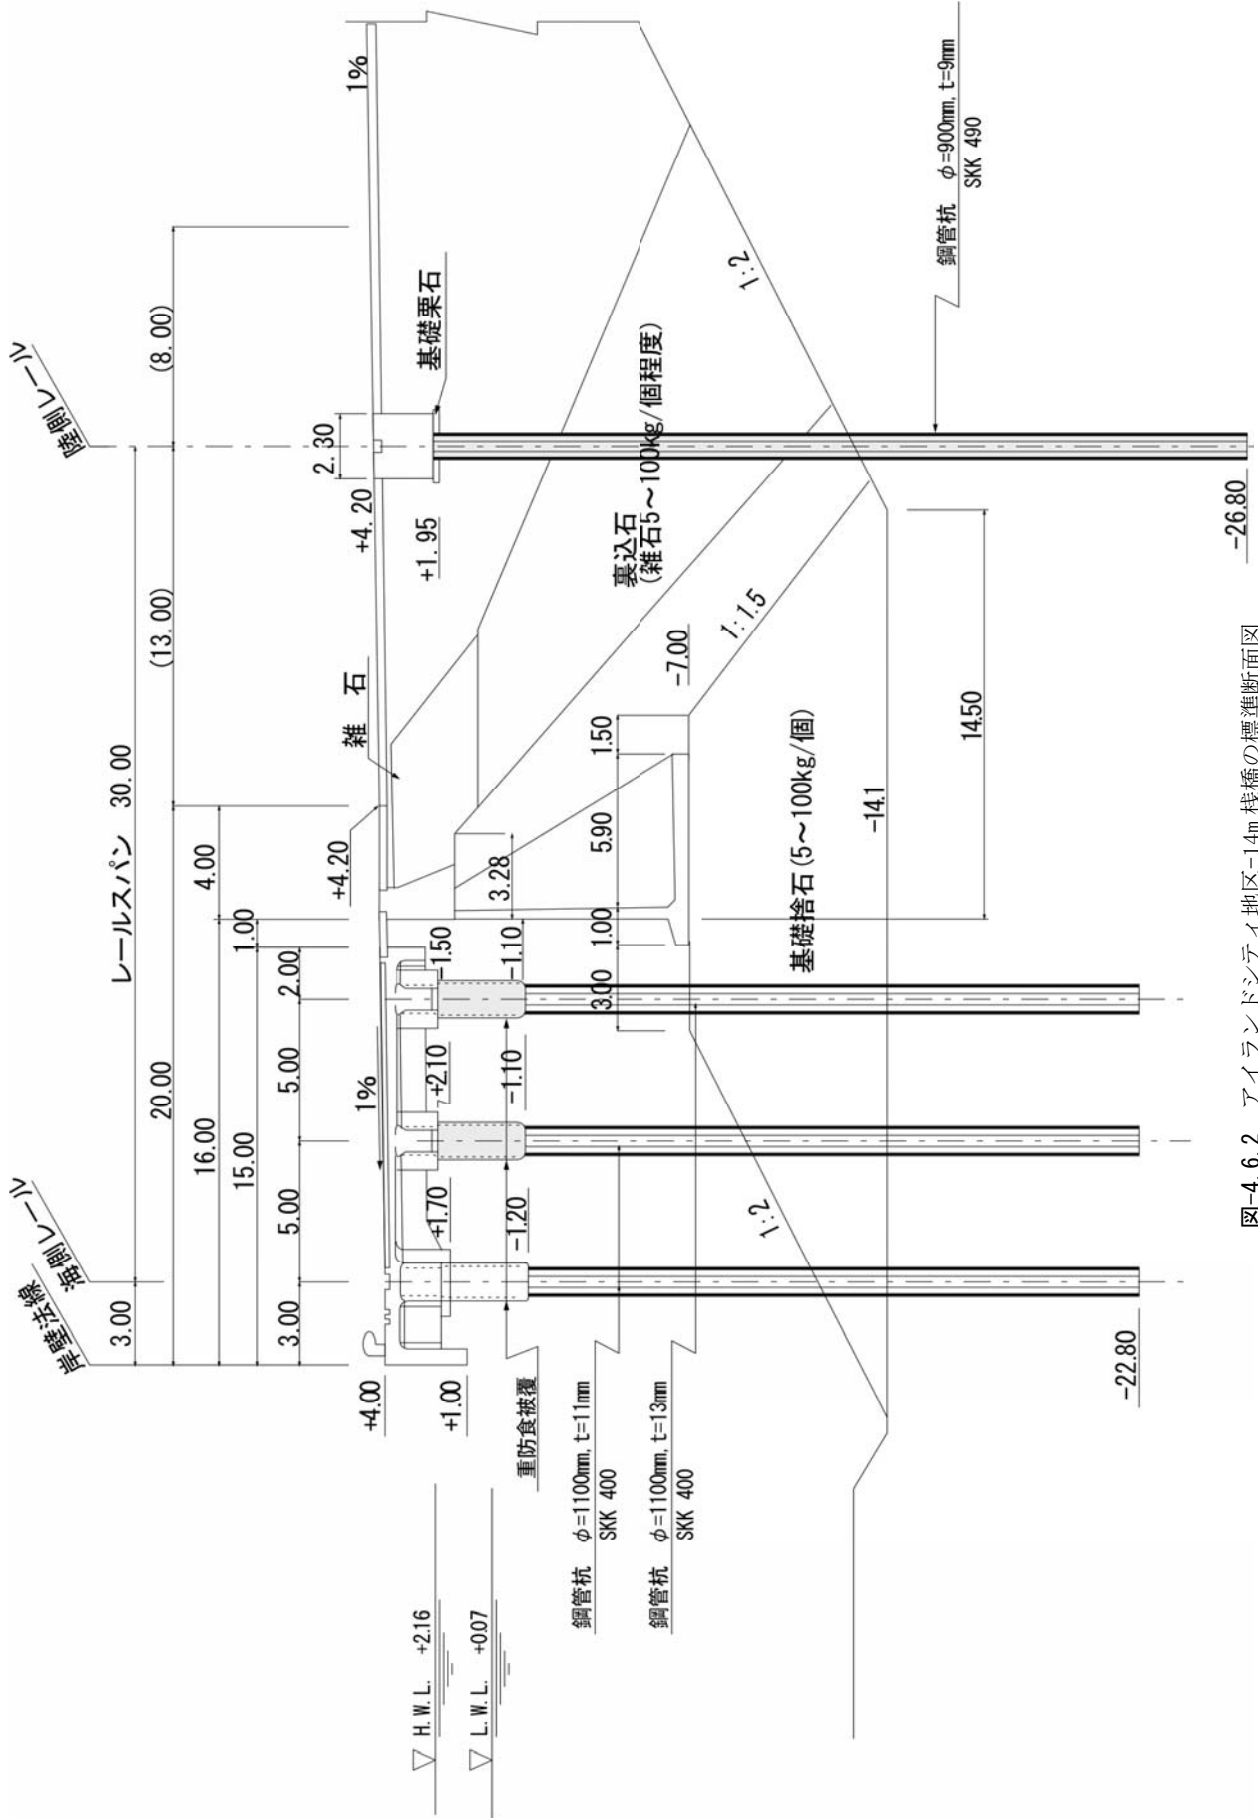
アイランドシティ地区-14m 栈橋の標準断面図
